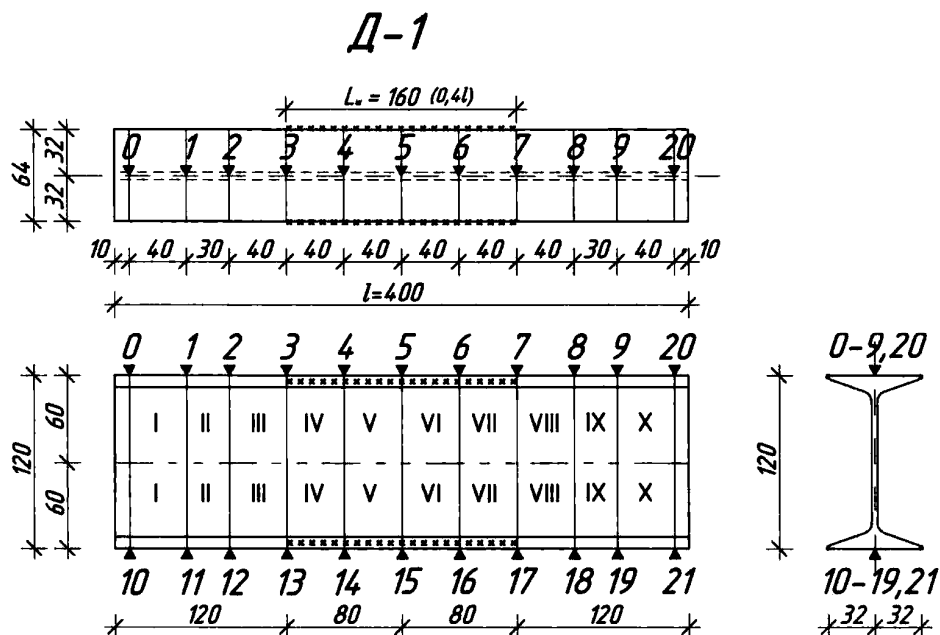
Схема наплавления сварных валиков в образце Д-1
